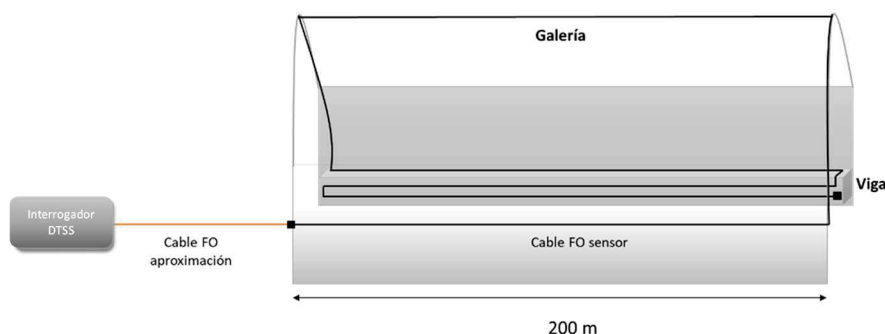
Propuesta de tendido longitudinal del cable en la galería de la Presa
